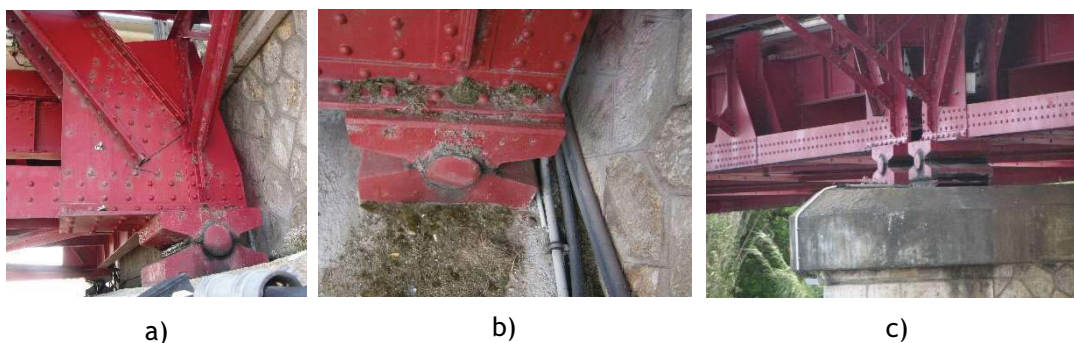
a) Dispositivo de apoio de articulações fixas (E1). b) Dispositivo de apoio de articulações fixas (E1). c) Dispositivo de apoio de articulações móveis (P2).
